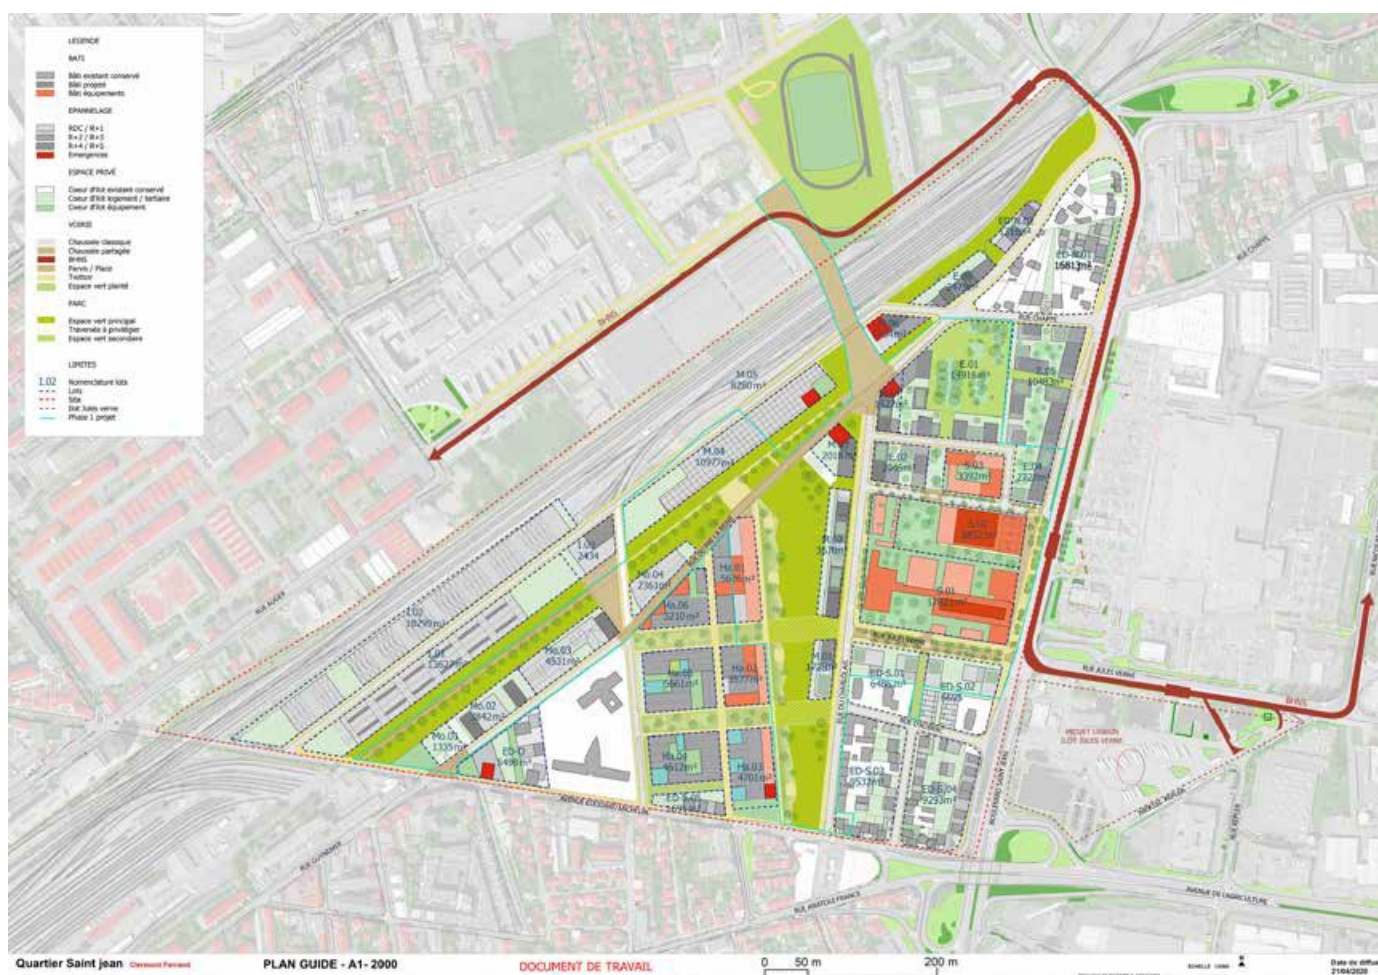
Plan guide projet Saint-Jean (plan guide avril 2020)
